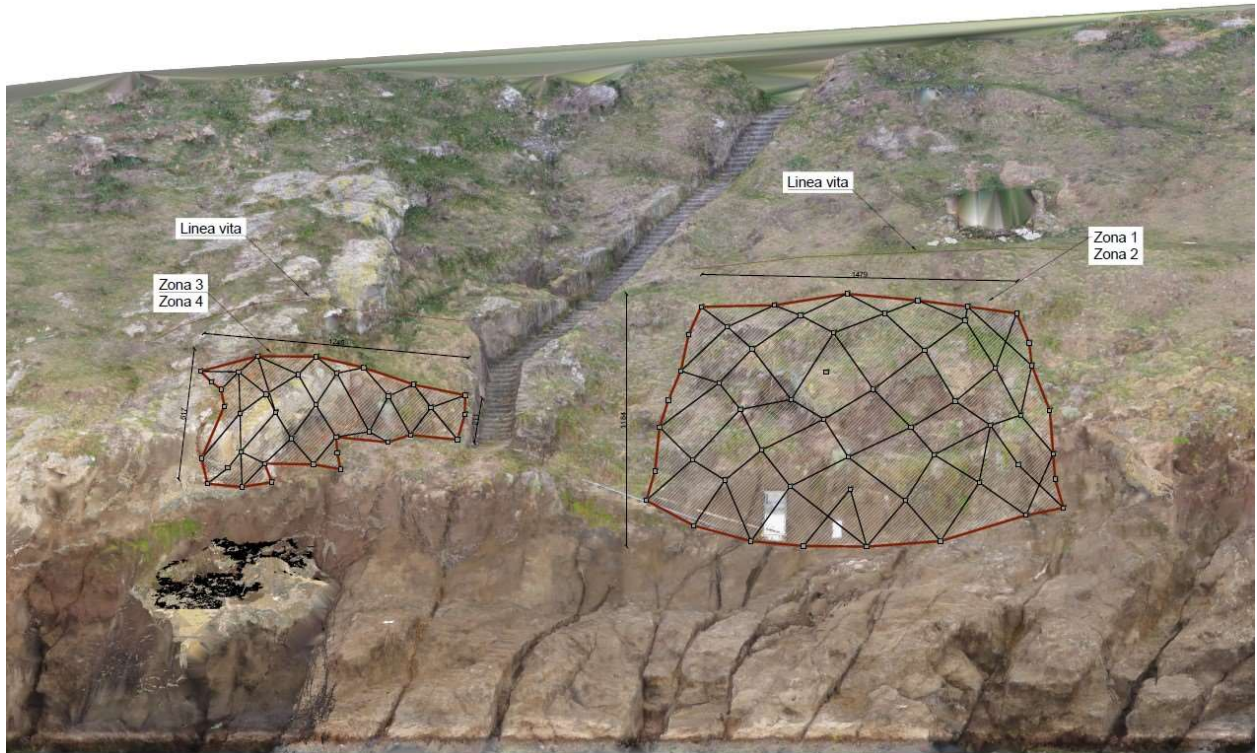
Zone di intervento – vista prospettica con schematizzazione degli interventi
